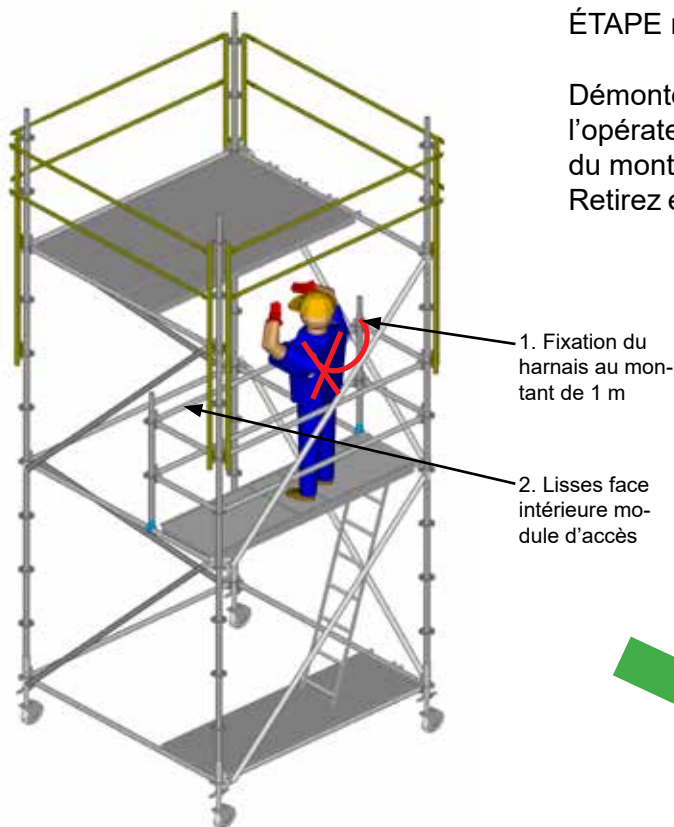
Démontage du plancher d'accès du dernier niveau. Fixation du harnais au montant de 1 m. Démontage de la protection latérale intérieure.
